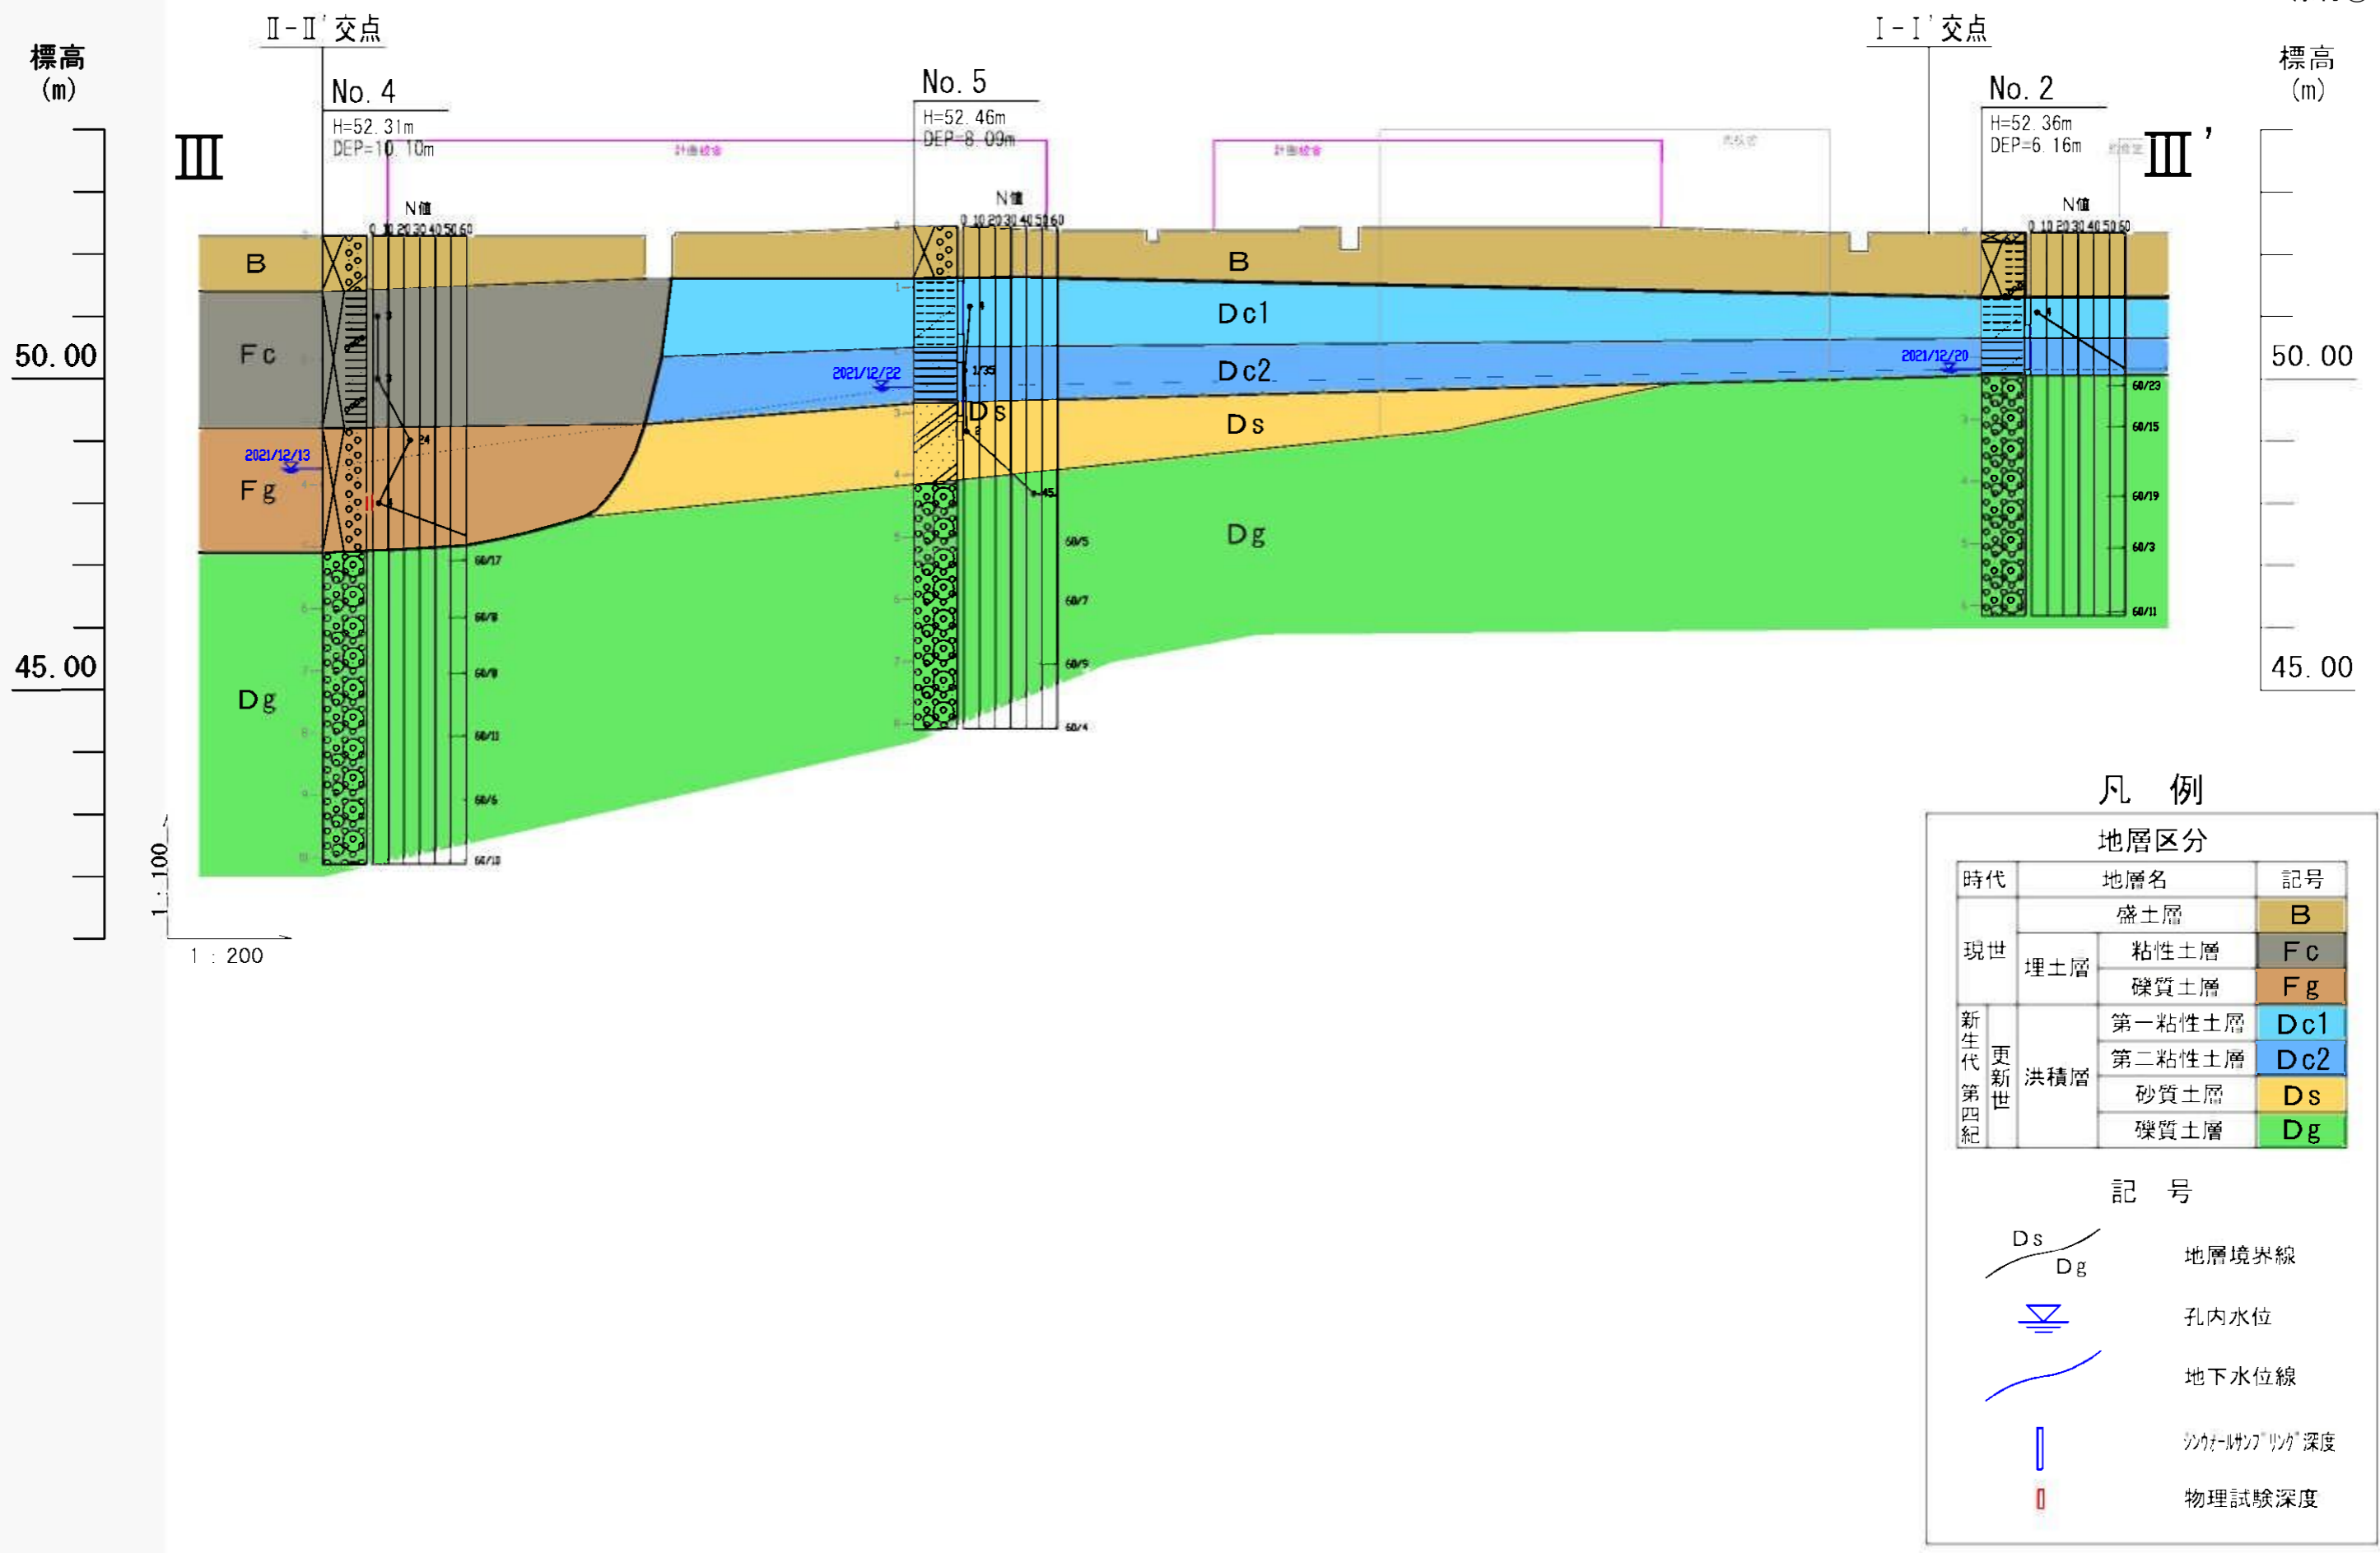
III-III' 地層断面図 (縮尺V=1:100, H=1:200)
